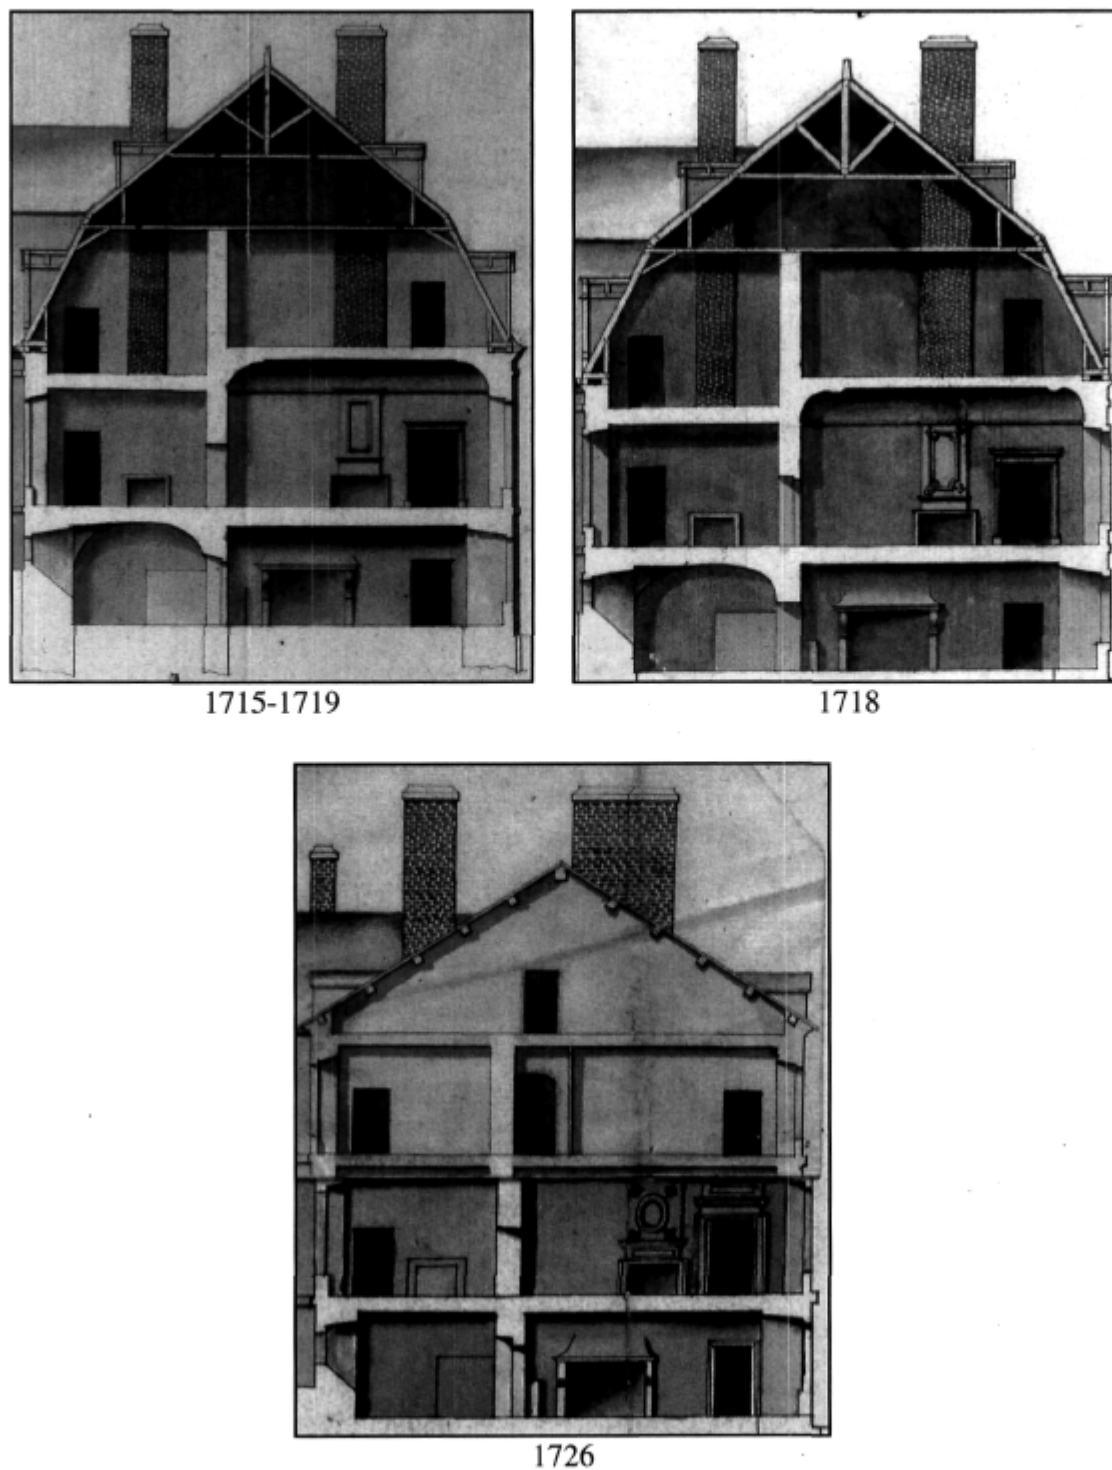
Coupes transversales du Palais. Extraits des plans de Chaussegros de Léry entre 1715 et 1726.
